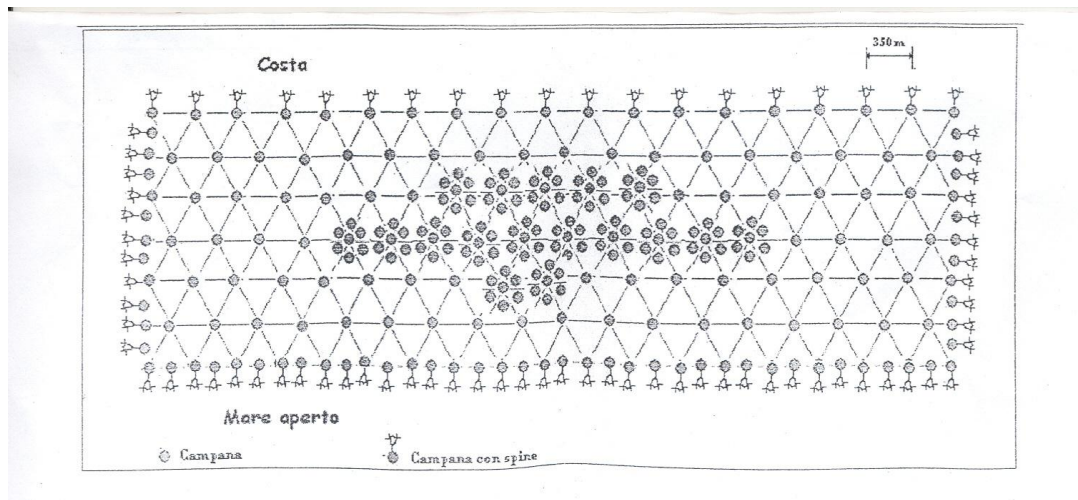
Disposizione a “quinconce” delle campane in calcestruzzo.
